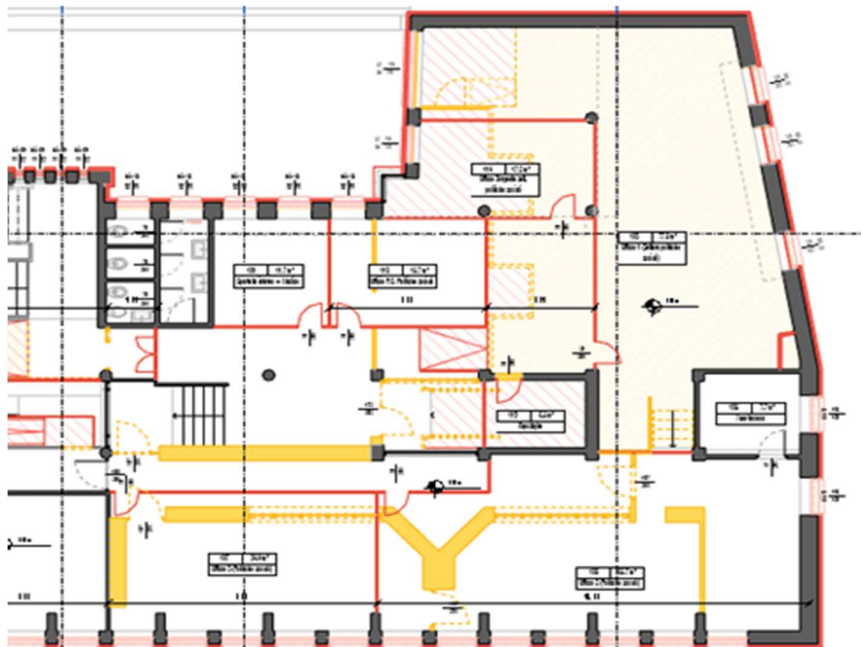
Pianta gialli e rossi - Ufficio anagrafe
